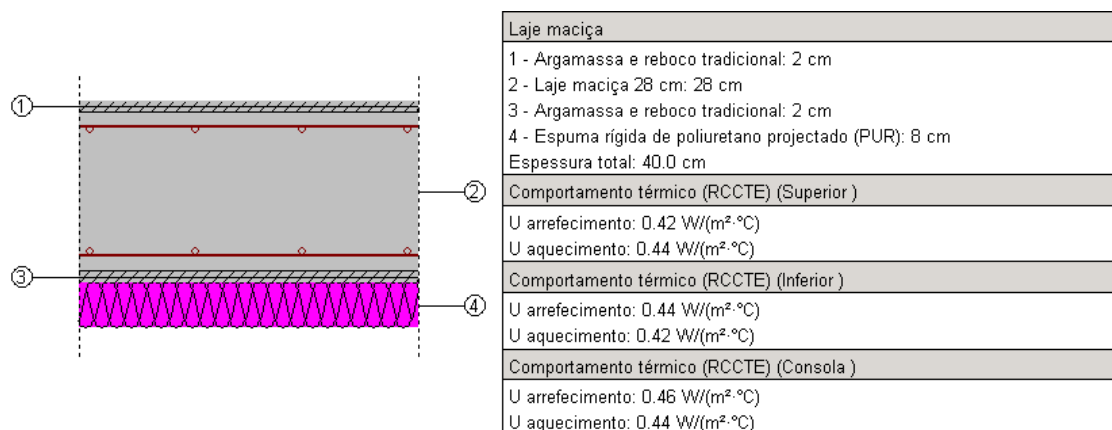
Constituição esquemática de pavimento entre pisos (software Cype).
